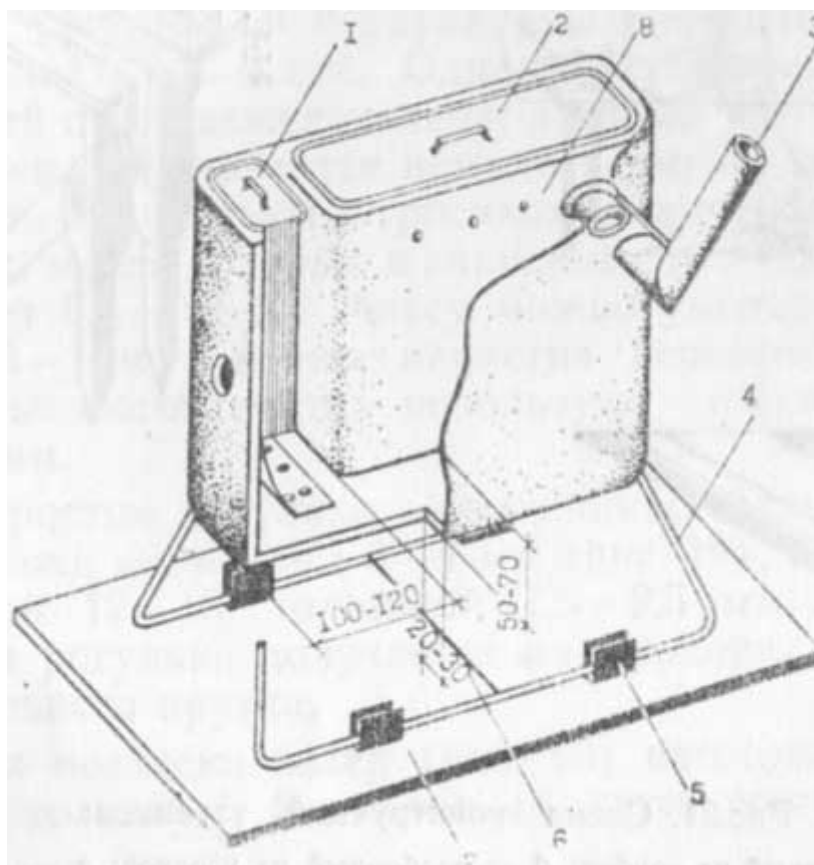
Схема напольной печки: 1 - дверца; 2 - крышка; 3 - труба; 4 - ножки; 5 - скобки; 6 - тросик; 7 - фанера; 8 - бачок
